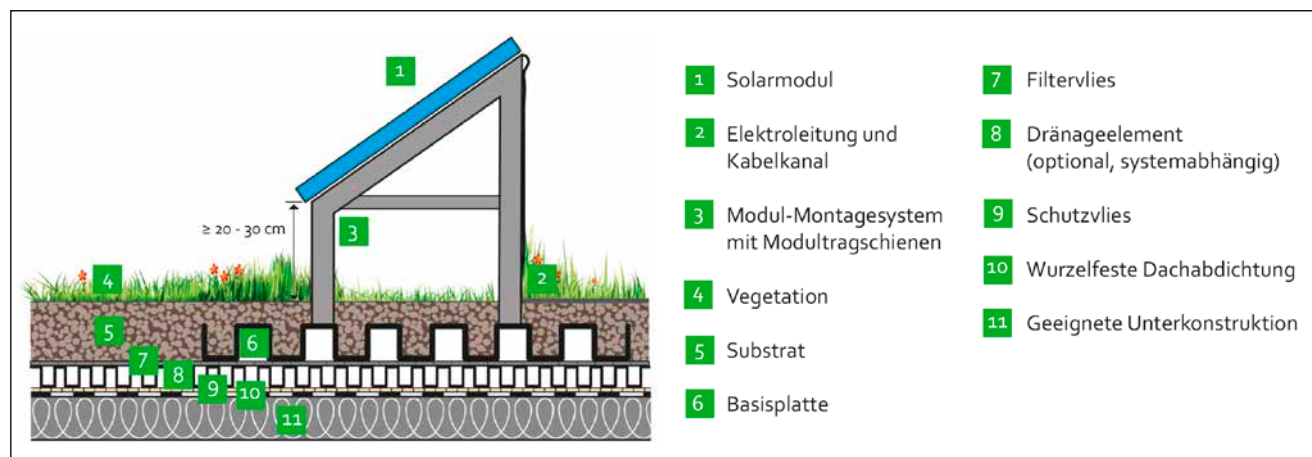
Schematischer Schnitt durch ein auflastgehaltene Solar-Gründach. Der Gründachaufbau hält die PV-Aufständerung lagesicher und ohne Dachdurchdringung
